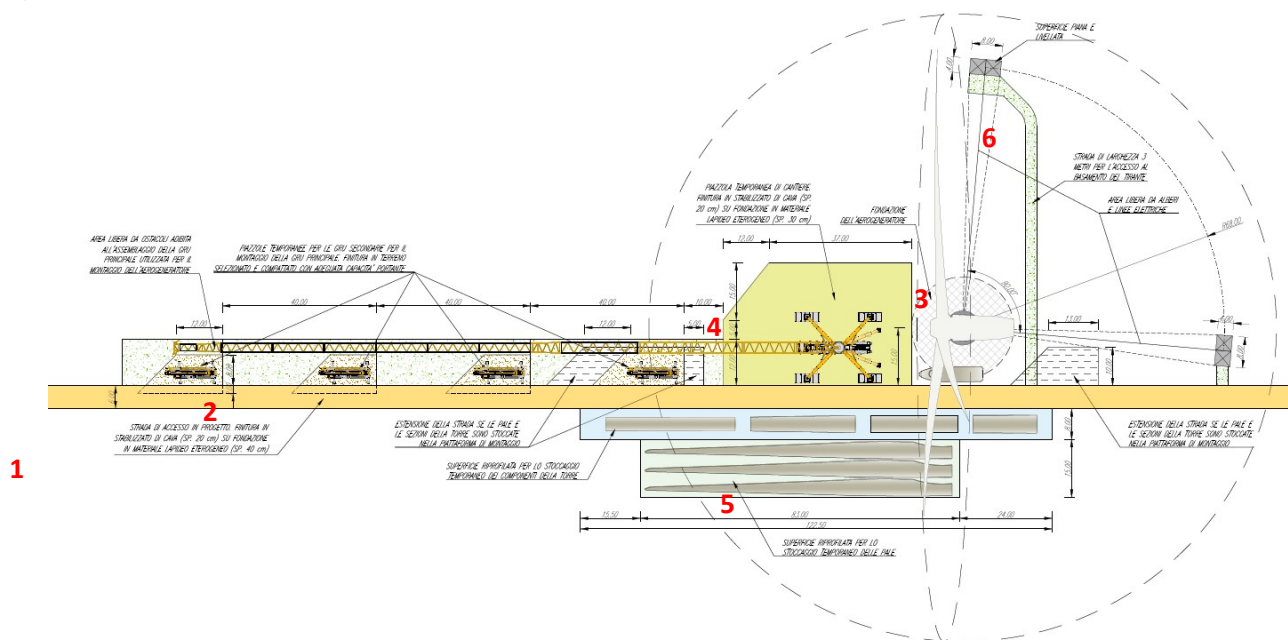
Piazzola di montaggio; 1. Strada di accesso; 2. Blocchi ausiliari; 3. Area di assemblaggio della torre; 4. Area di lavoro gru principale; 5. Area di stoccaggio; 6. Blocchi di ancoraggio - controvento.
